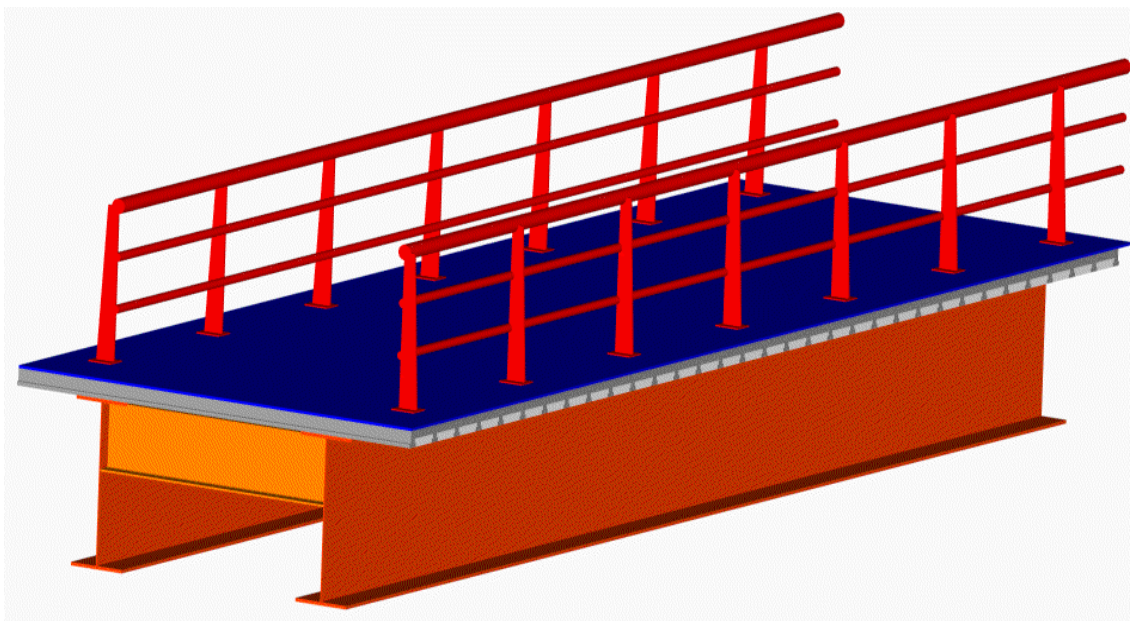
Perspectiva da solução em viga metálica a adoptar
